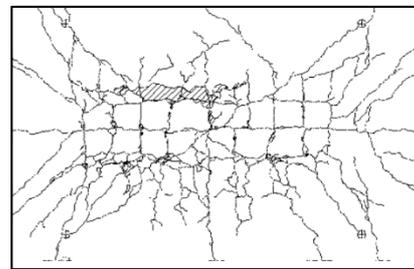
ソフトによる床版試験体のひび割れ抽出
